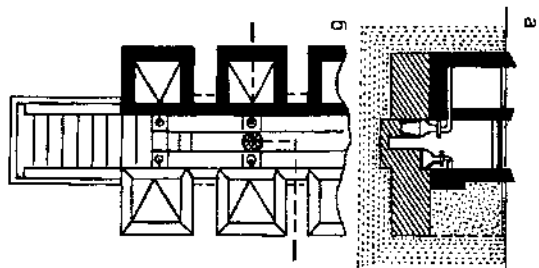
Насыщенные бетонные лизиметры: а - вертикальный разрез; б - горизонтальный разрез.
